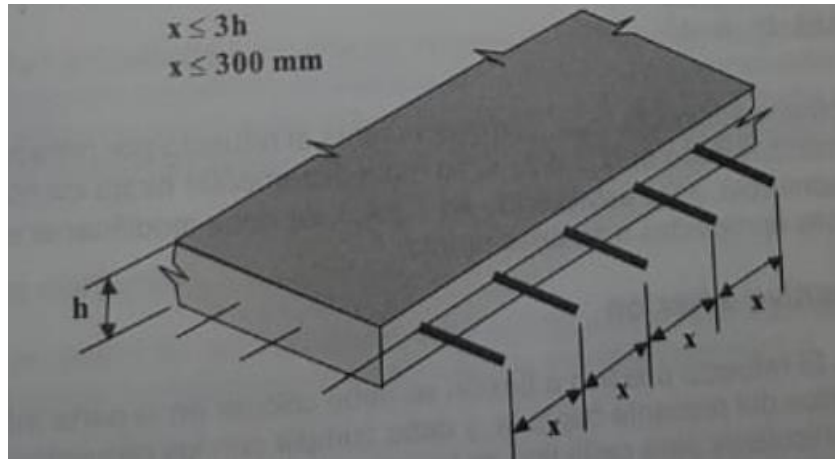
Separación máxima del refuerzo en losas reforzadas.
